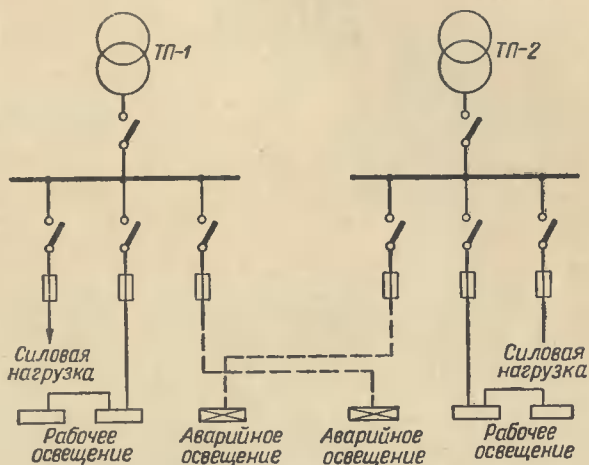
Схема электроснабжения осветительной и силовой нагрузки.
